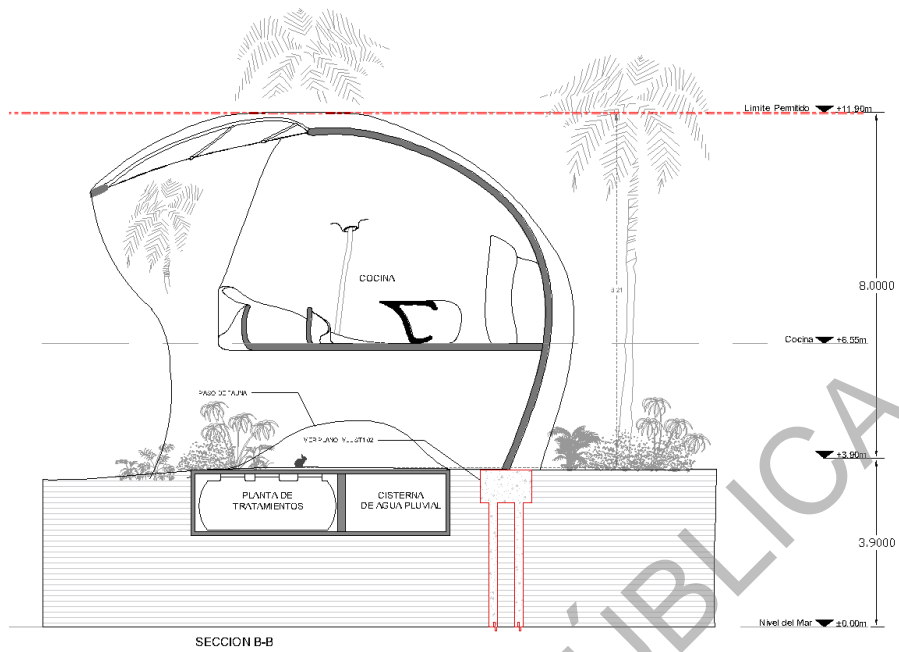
Ubicación de planta de tratamiento y cisterna para recolección de agua pluvial.
